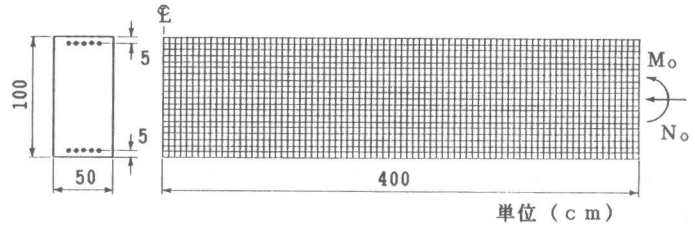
曲げと軸力を受ける鉄筋コンクリートはり
